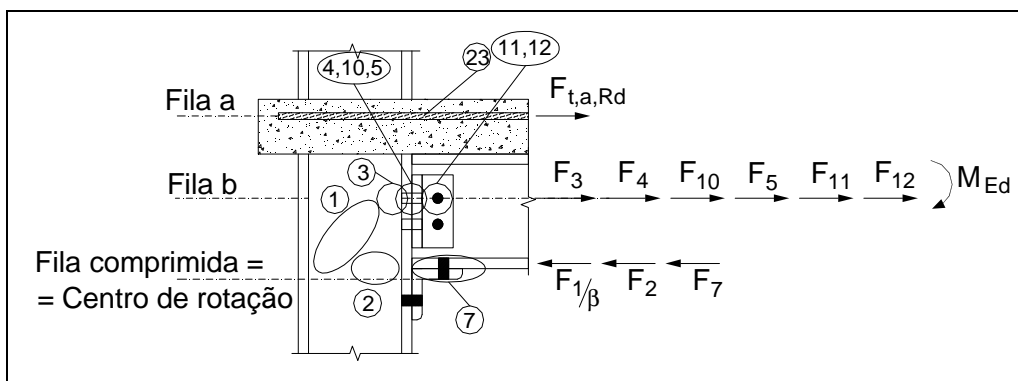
Ligação mista com cantoneiras de alma e assento e filas traccionadas a e b.
